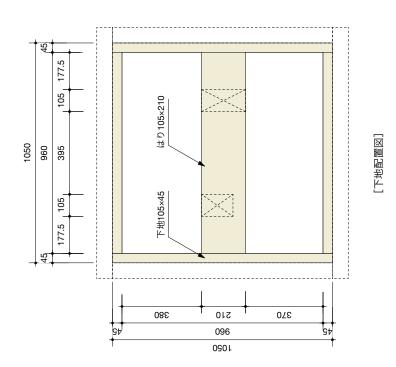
試験体 3-1 壁-床取合い部 試験体図
